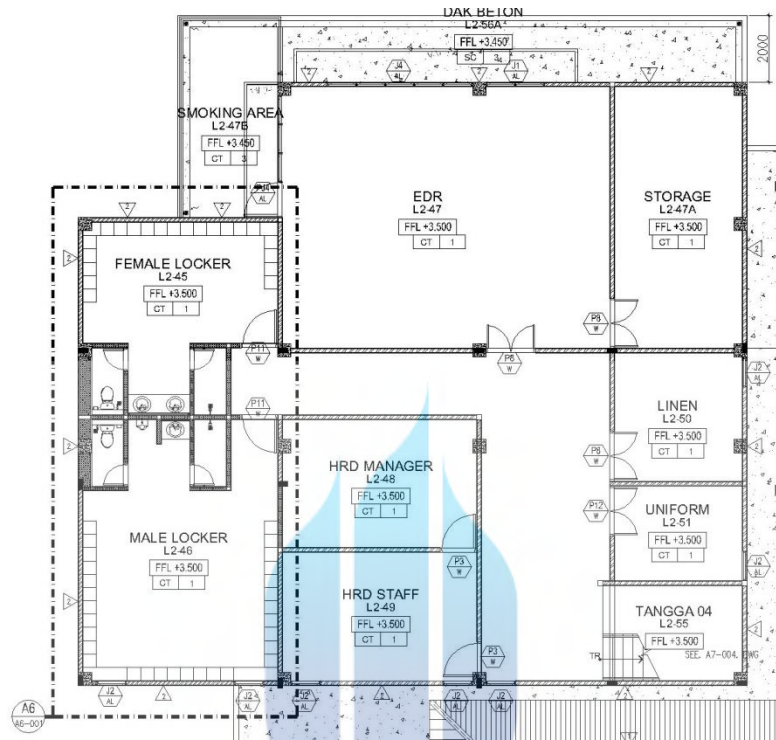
Visualisasi Denah Lantai 2 Dengan Keterangan Ruang
